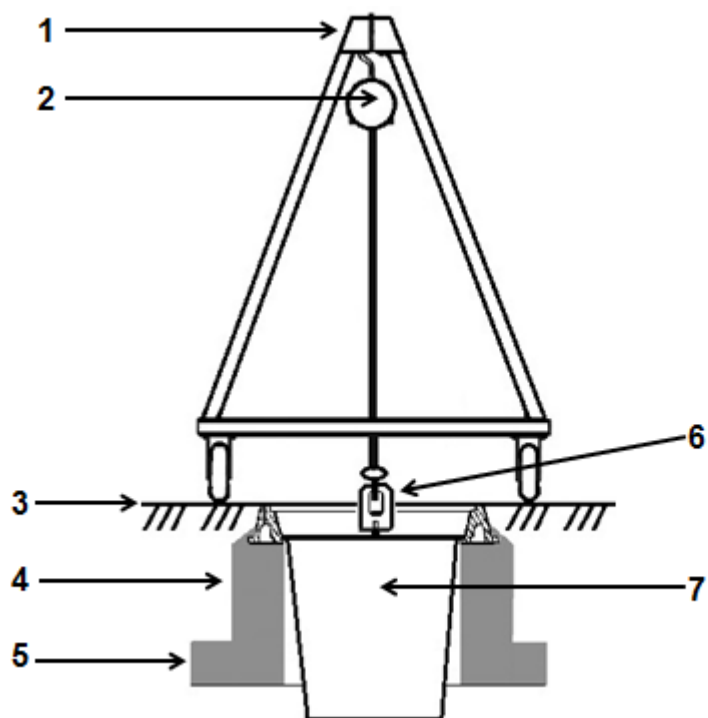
Подготовка к подъёму запорного устройства из люка колодца:
